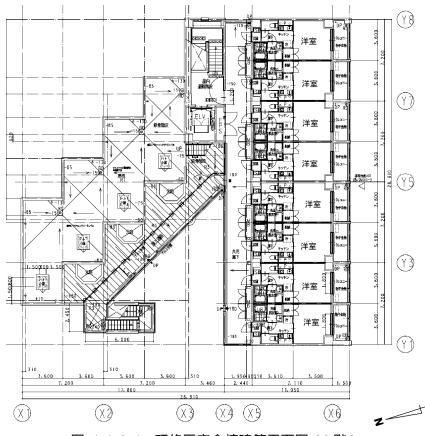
研修医宿舎棟建築平面図 (6階)
